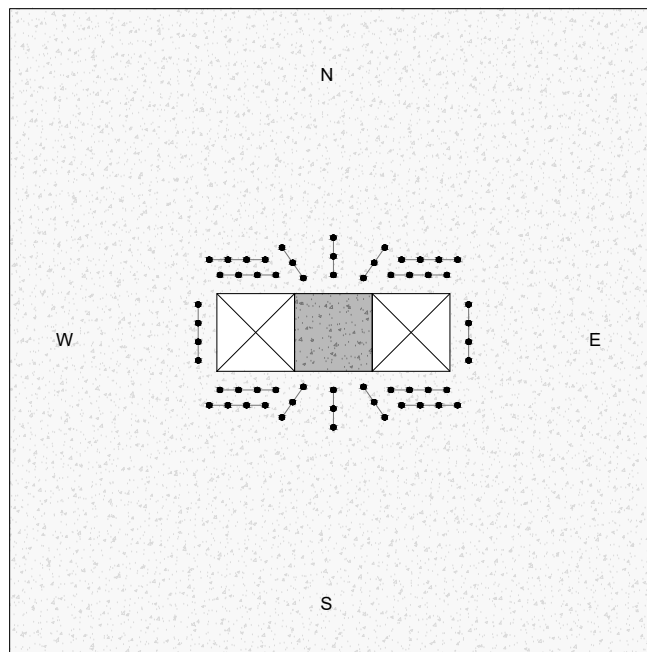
Laje LFS2 - Armadura de cisalhamento
